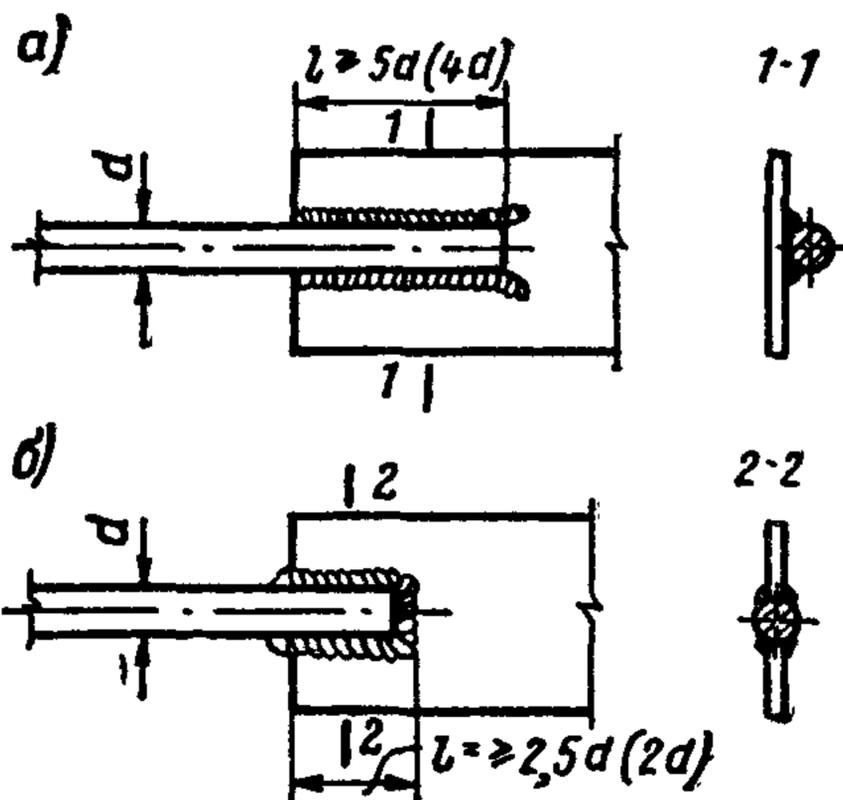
Схемы соединения арматурных стержней с плоскими элементами закладных деталей электродуговой сваркой швами
